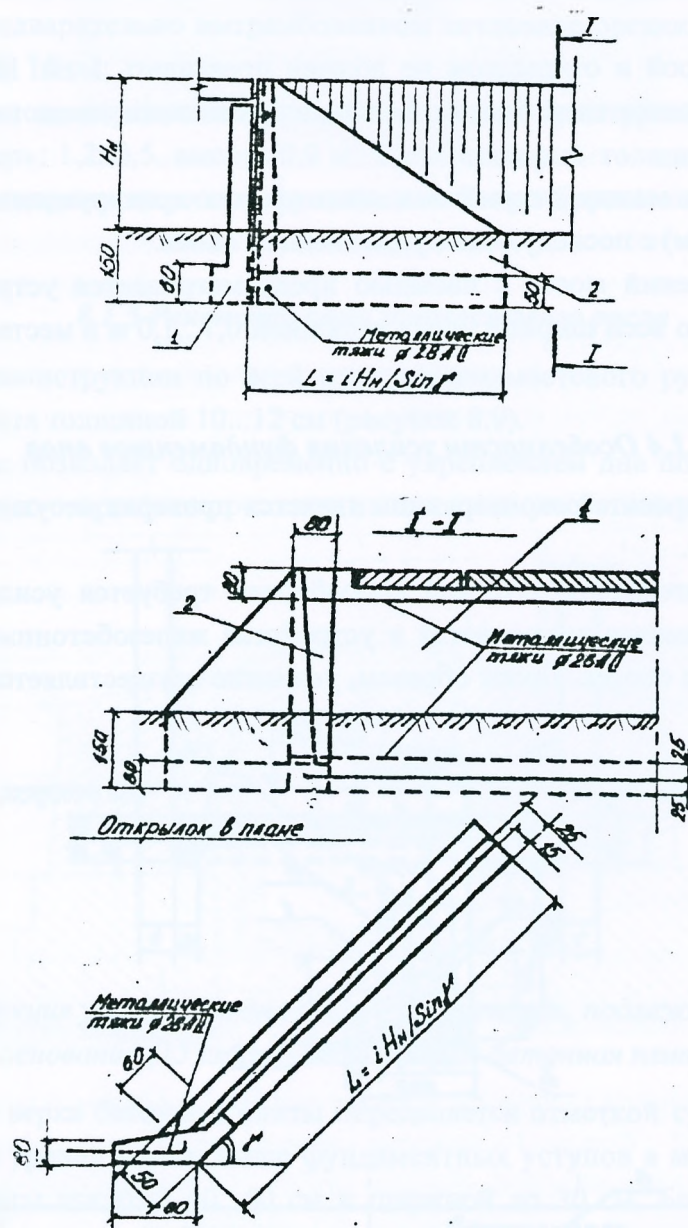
Конструкция монолитного открылка (вариант – примыкание под углом α к опоре): 1 – опора-стенка; 2 – монолитный открылок; 3 – металлические тяжи.
